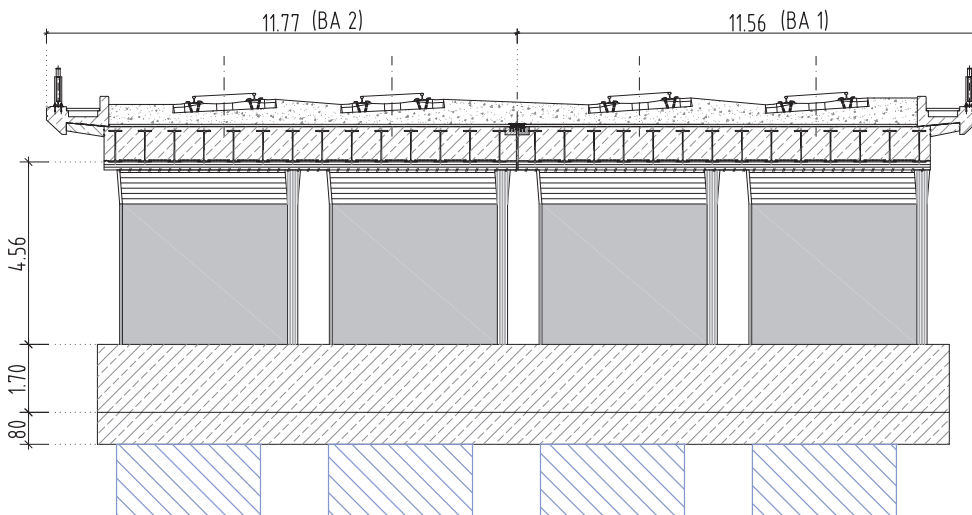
Angebotsentwurf – Bauwerksquerschnitt
